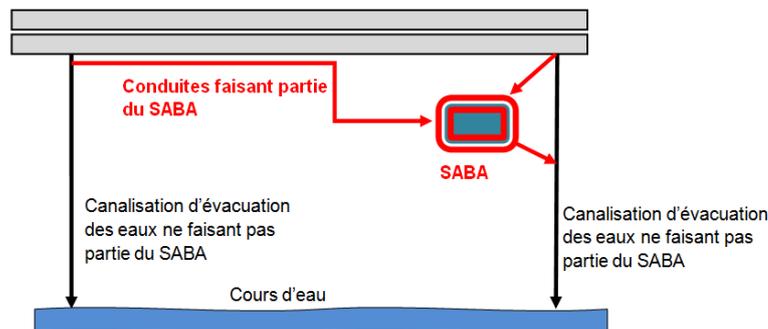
Conduites faisant partie du SETEC et autres canalisations.
